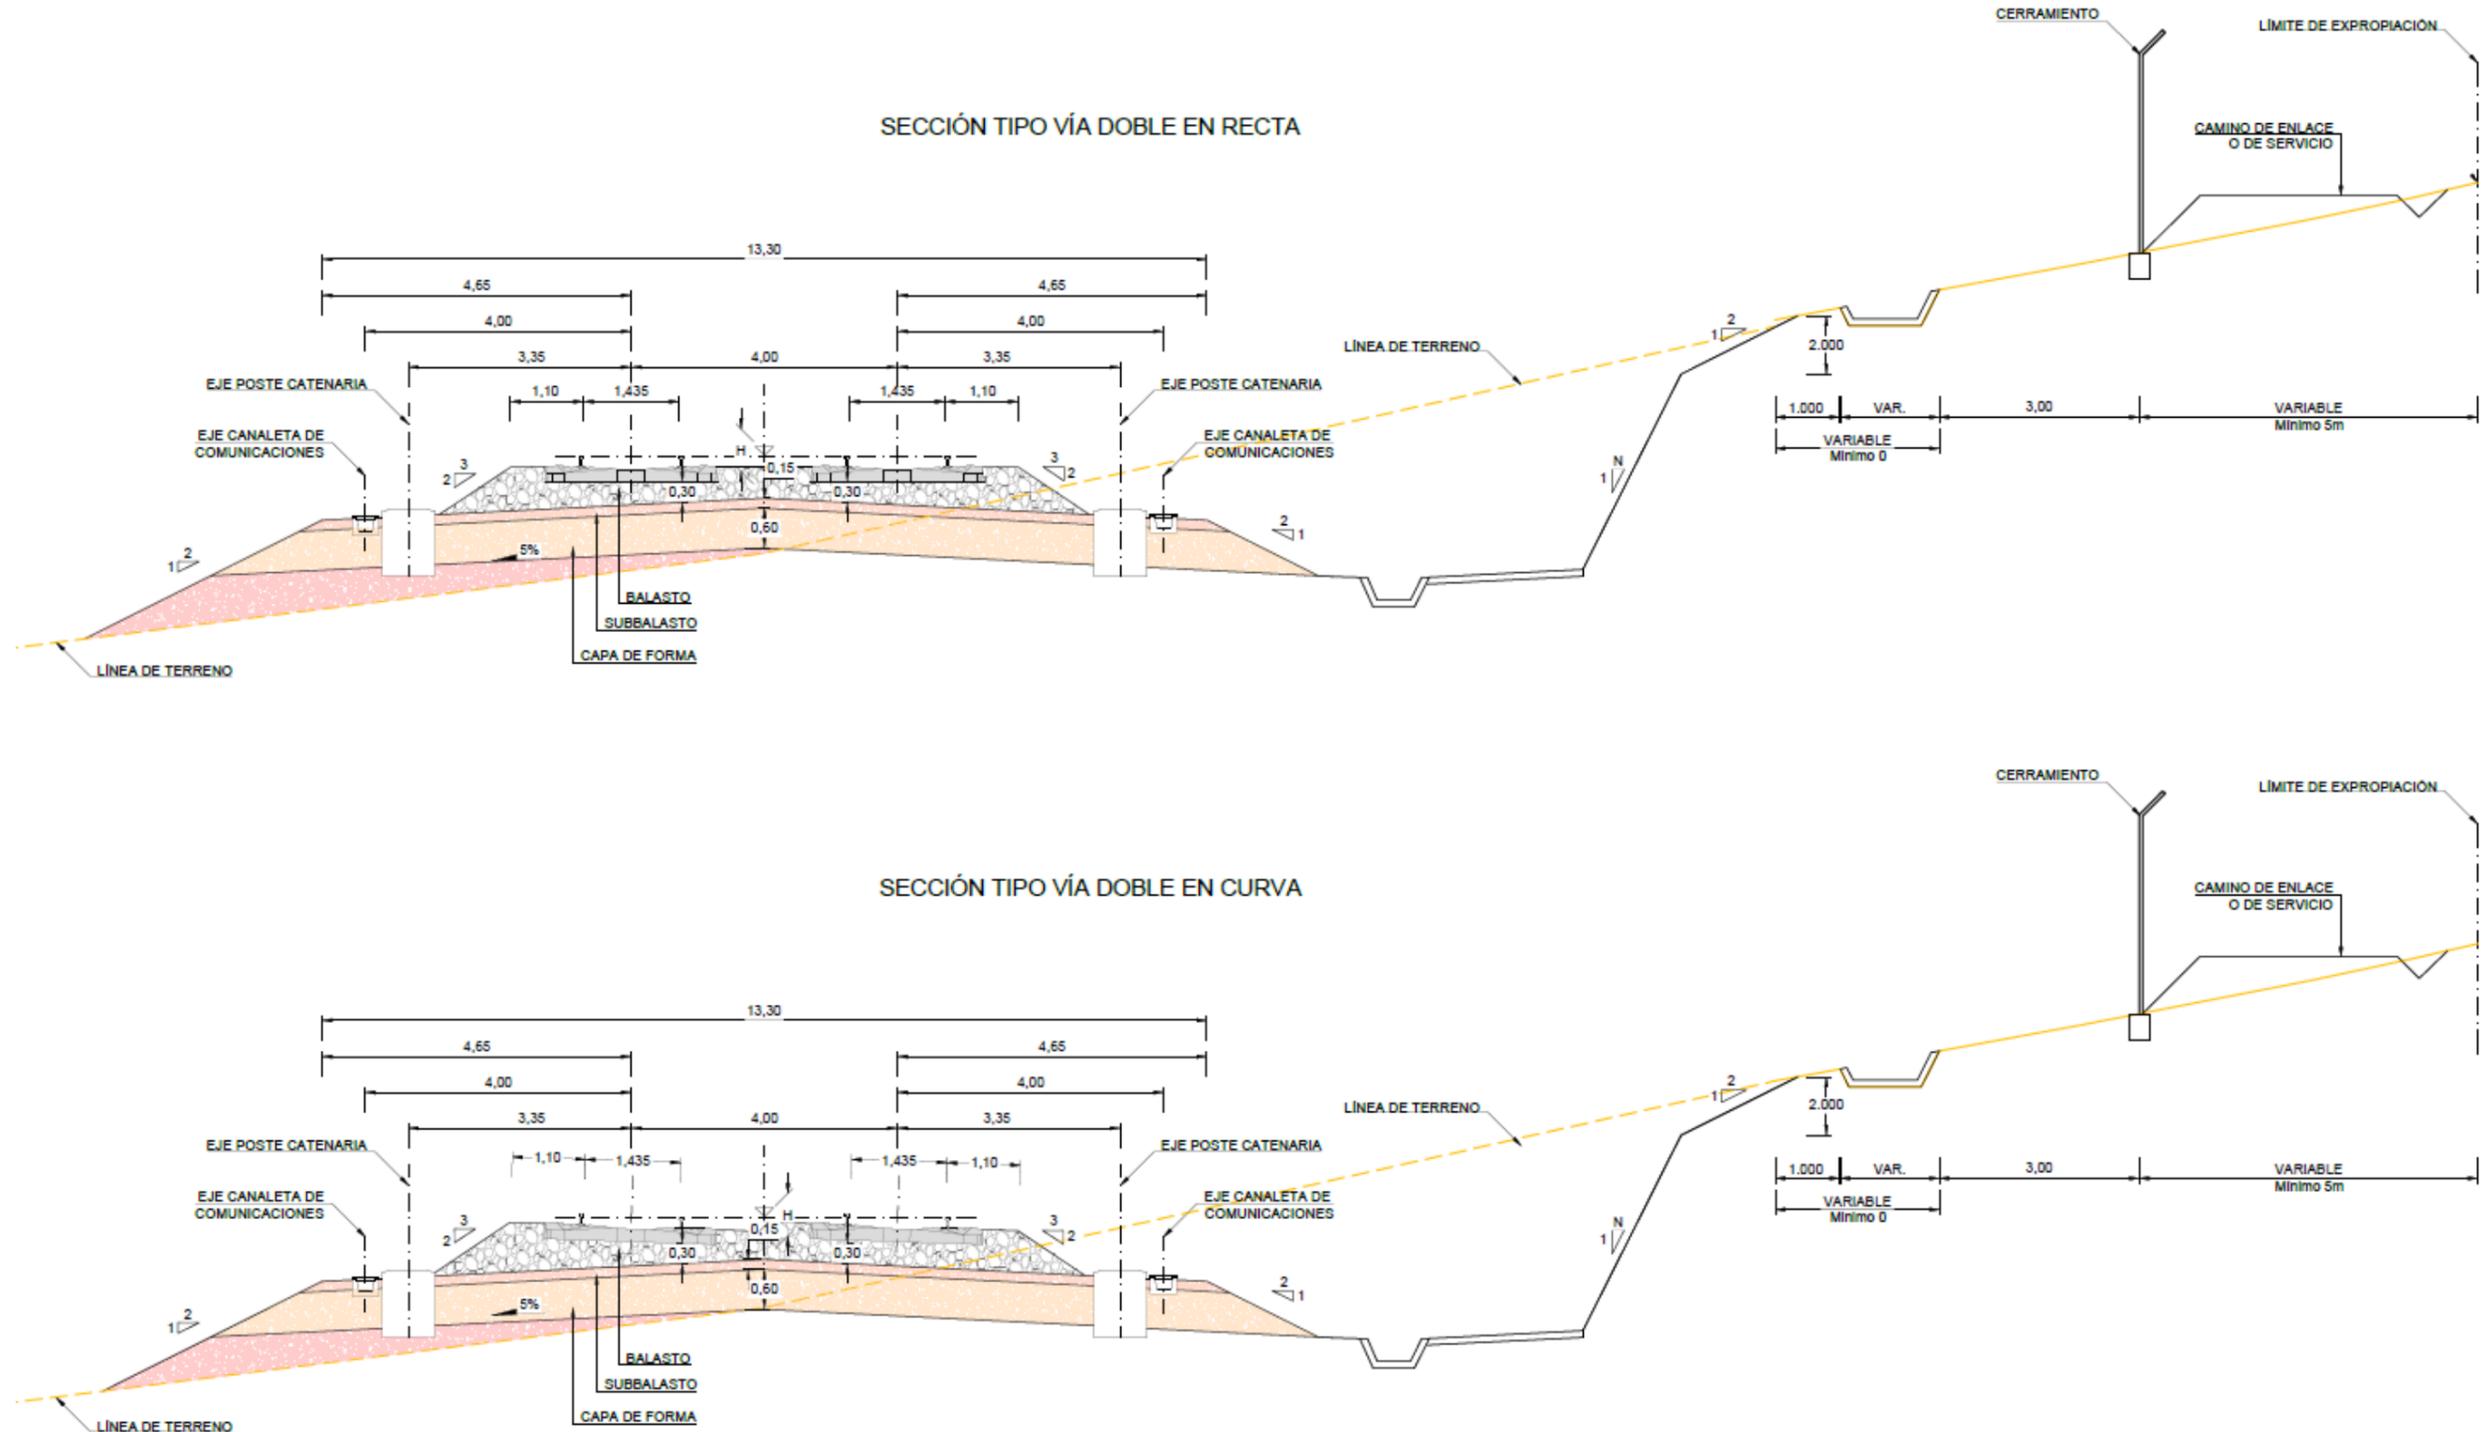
Sección tipo en obra de tierra. Vía doble.
